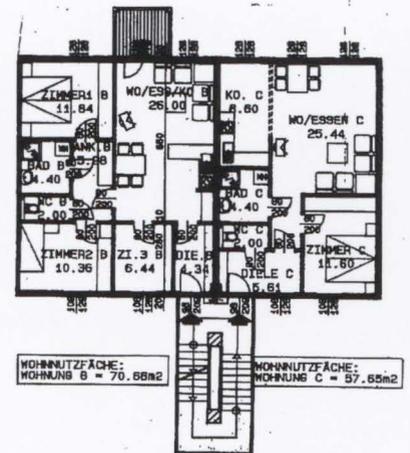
Grundrisse Faunastraße und Josef- Bayergasse
